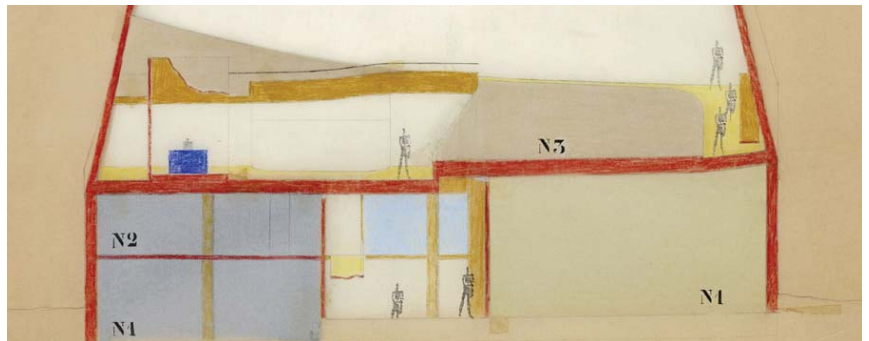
Detalle del dibujo en sección con el pilar en las sacristías baja y alta, perteneciente a la cuarta versión. Fuente: FLC. 32235
